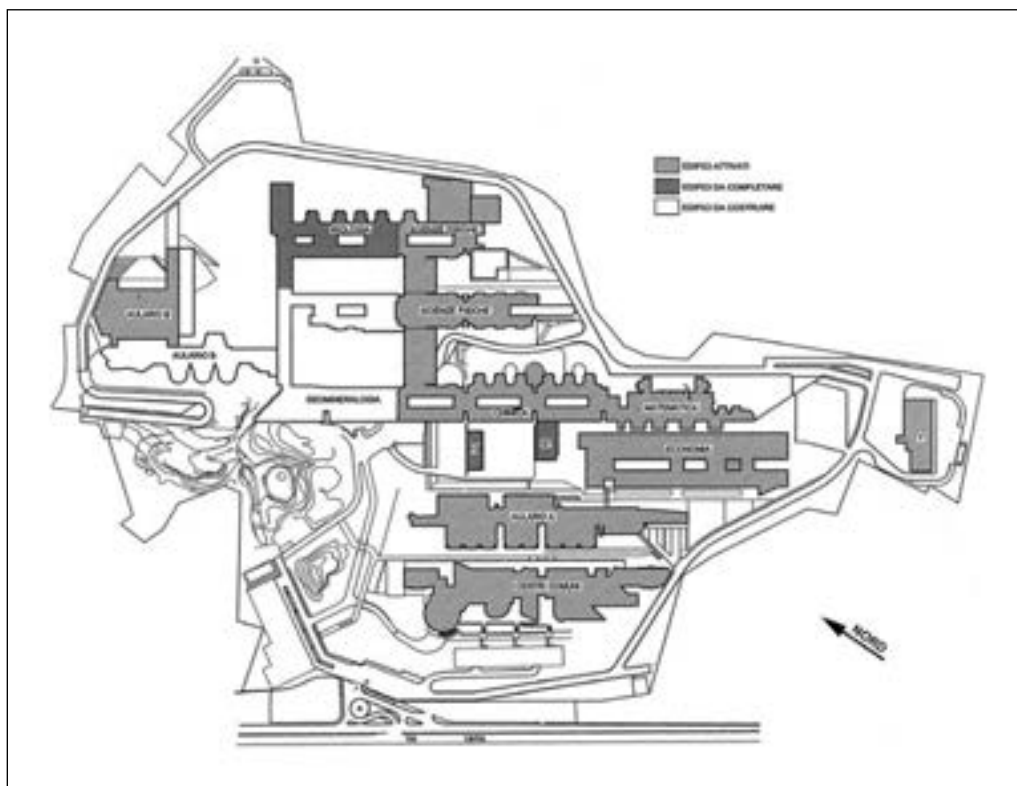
Napoli. Campus di Monte Sant'Angelo. Planimetria generale (Archivio Capobianco, Napoli).
